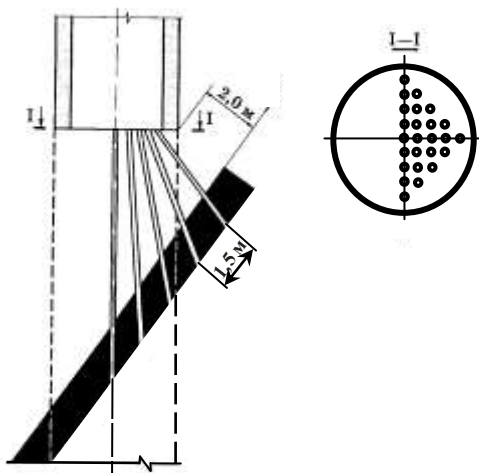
Схема розташування дренажних свердловин при розкритті крутих і крутопохилих пластів.
